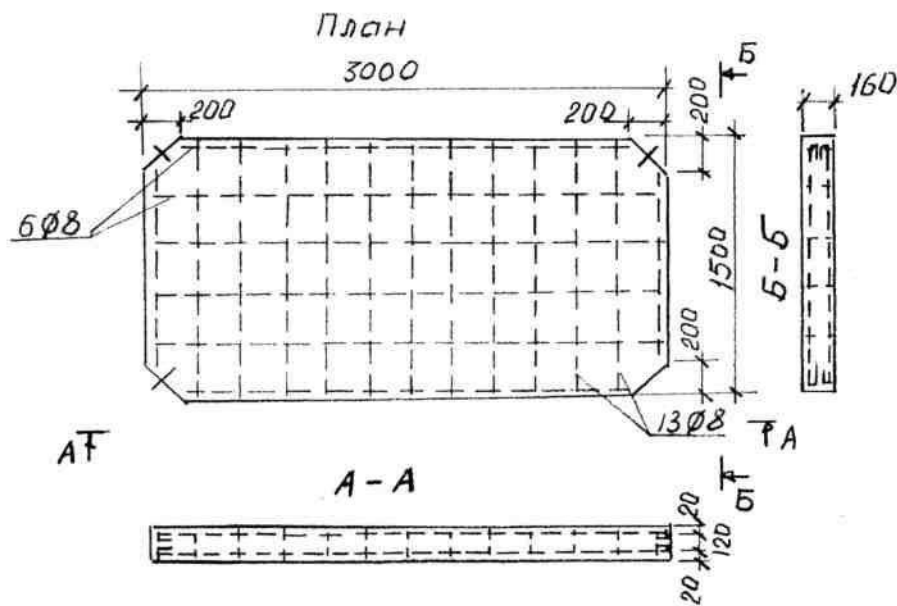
Конструкція залізобетонної плити збірного дорожнього покриття
